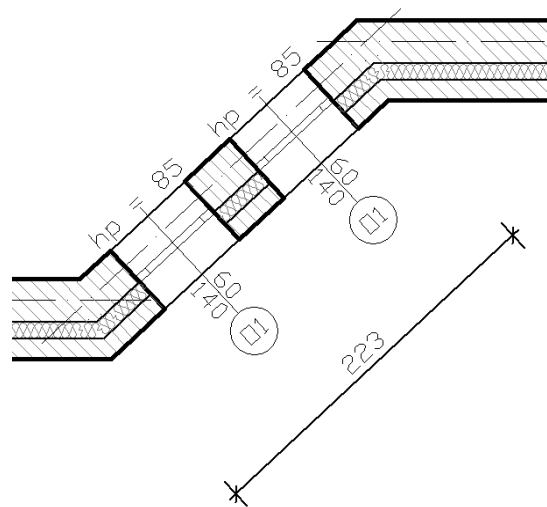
Ergebnis für die Bearbeitung der Bemaßung
